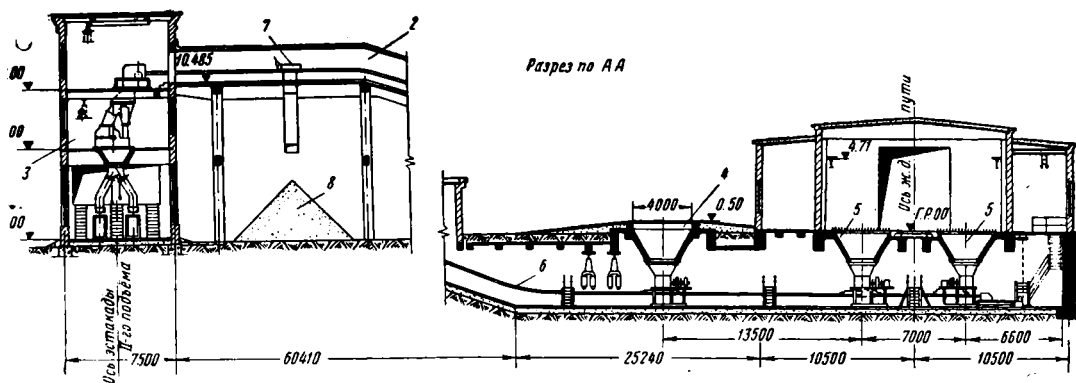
Базисный склад топлива, обслуживаемый скреперной установкой (схема С-8): 1—ленточный конвейер первого подъёма; 2—ленточный конвейер второго подъёма; 3—скреперная лебёдка; 4—скрепер; 5—приёмно-разгрузочное устройство склада; 6—лотковый питатель; 7—приёмное устройство топливносп. дачи; 8—столбы для крепления хвостовых блоков
